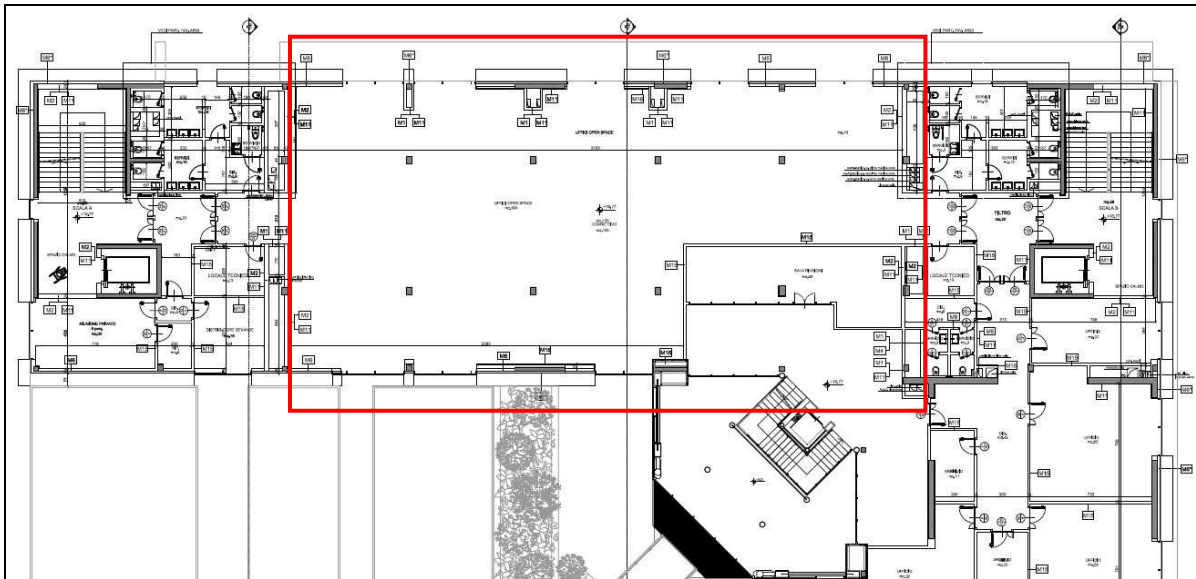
Stralcio della pianta del piano terzo con indicazione della collocazione dell'ambiente disturbato (open space).
